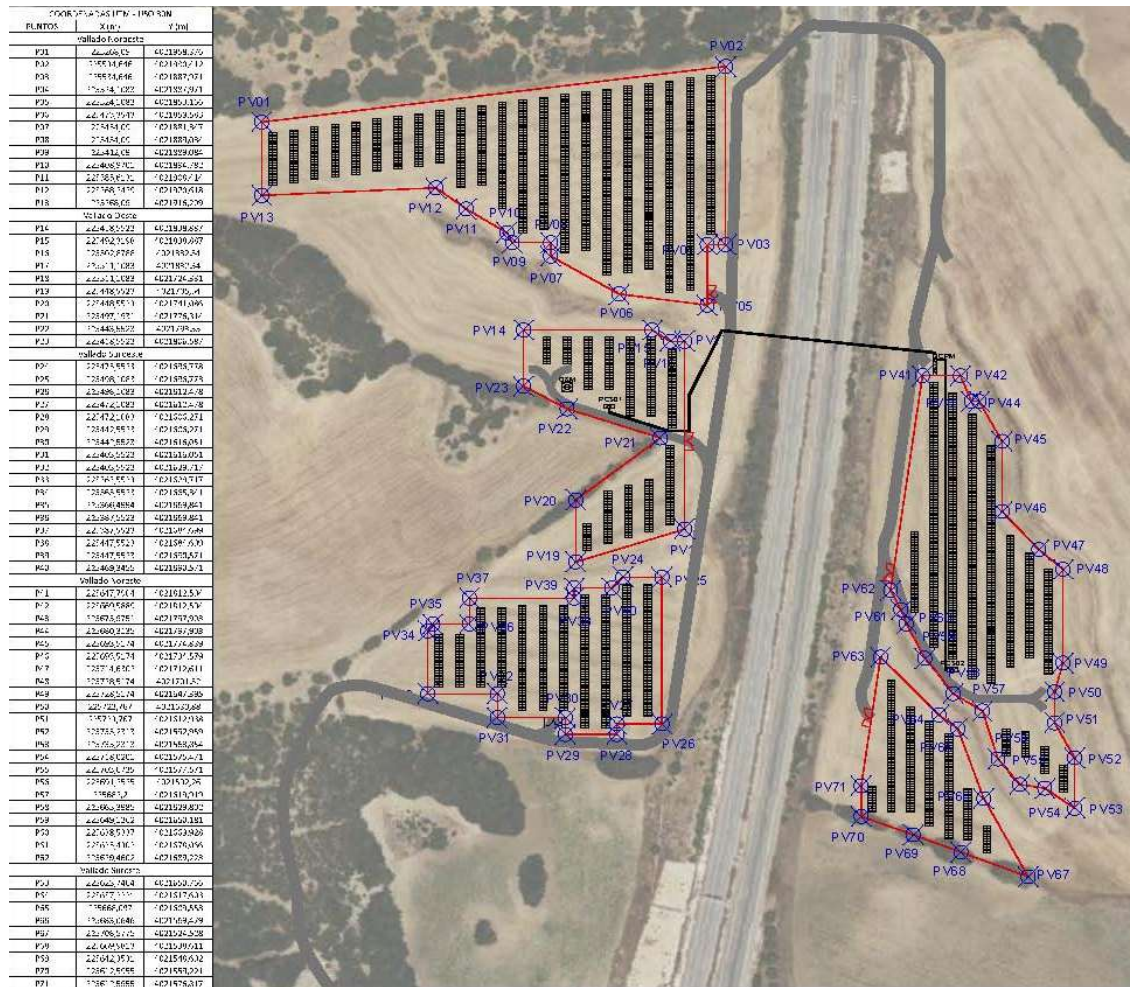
Coordenadas puntos vallado planta fotovoltaica
